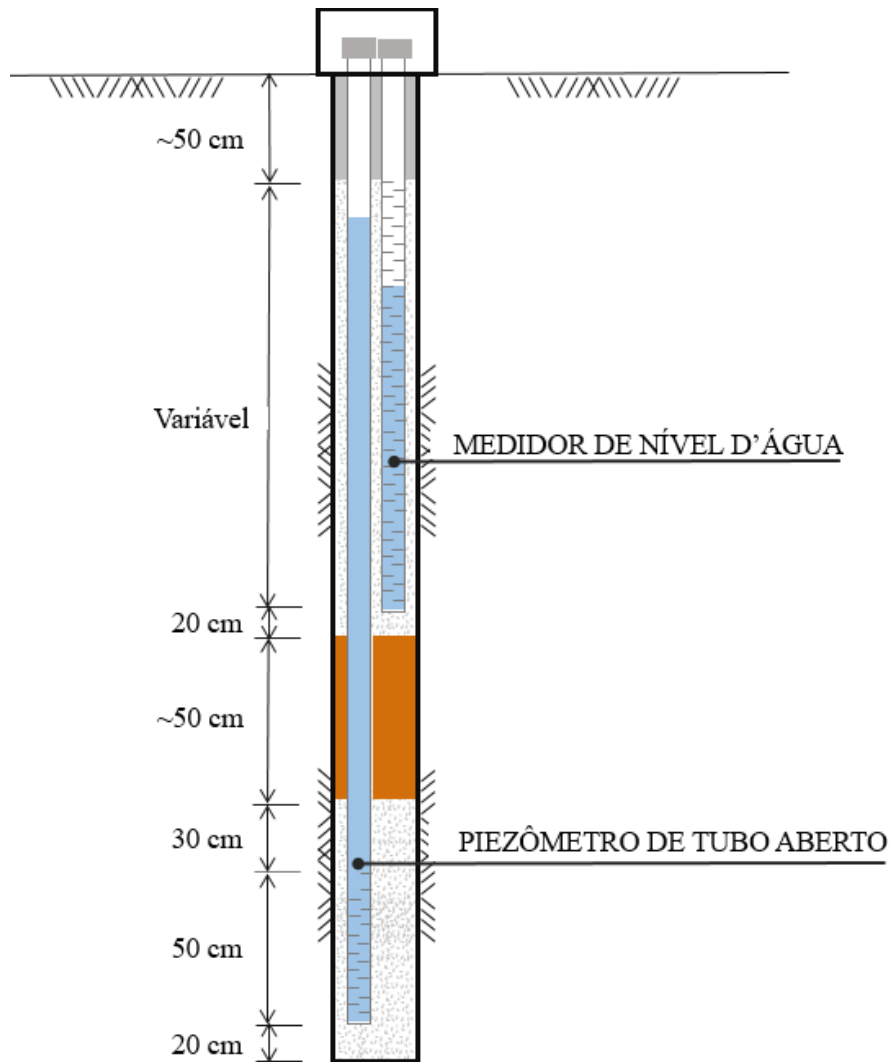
Perfil genérico da instalação conjunta de piezômetro de tubo aberto e medidor de nível d'água.
